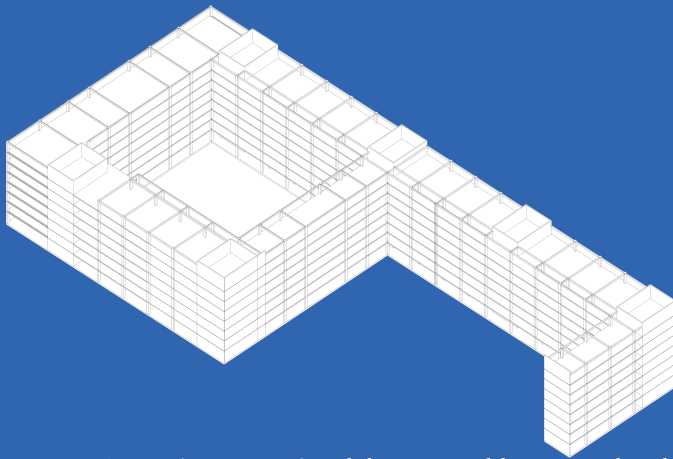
Axonométrica esquemática de la estructura del proyecto utilizando muros de hormigón armado para las circulaciones verticales y madera para el resto de la estructura
